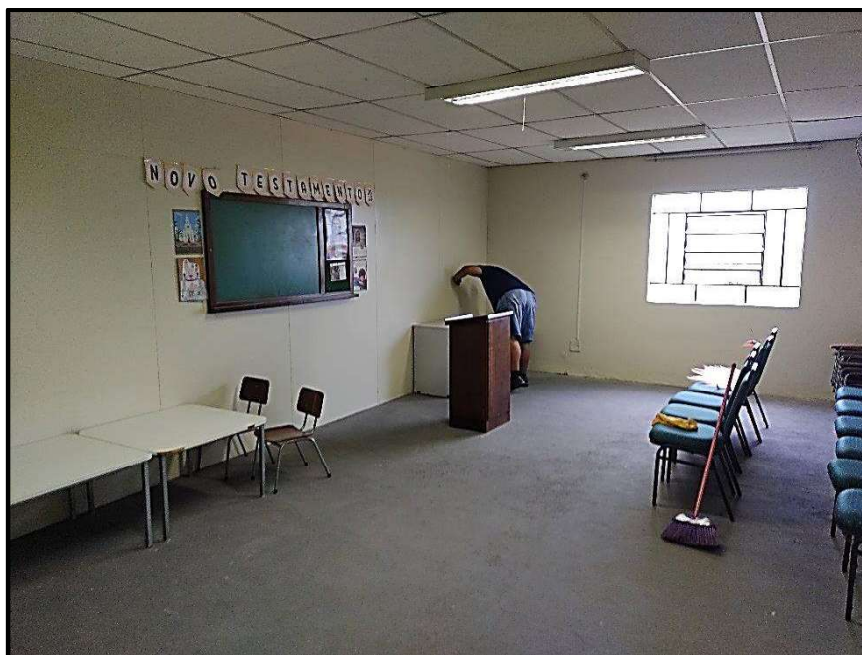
Aspecto interno de outra sala no pavimento superior.
